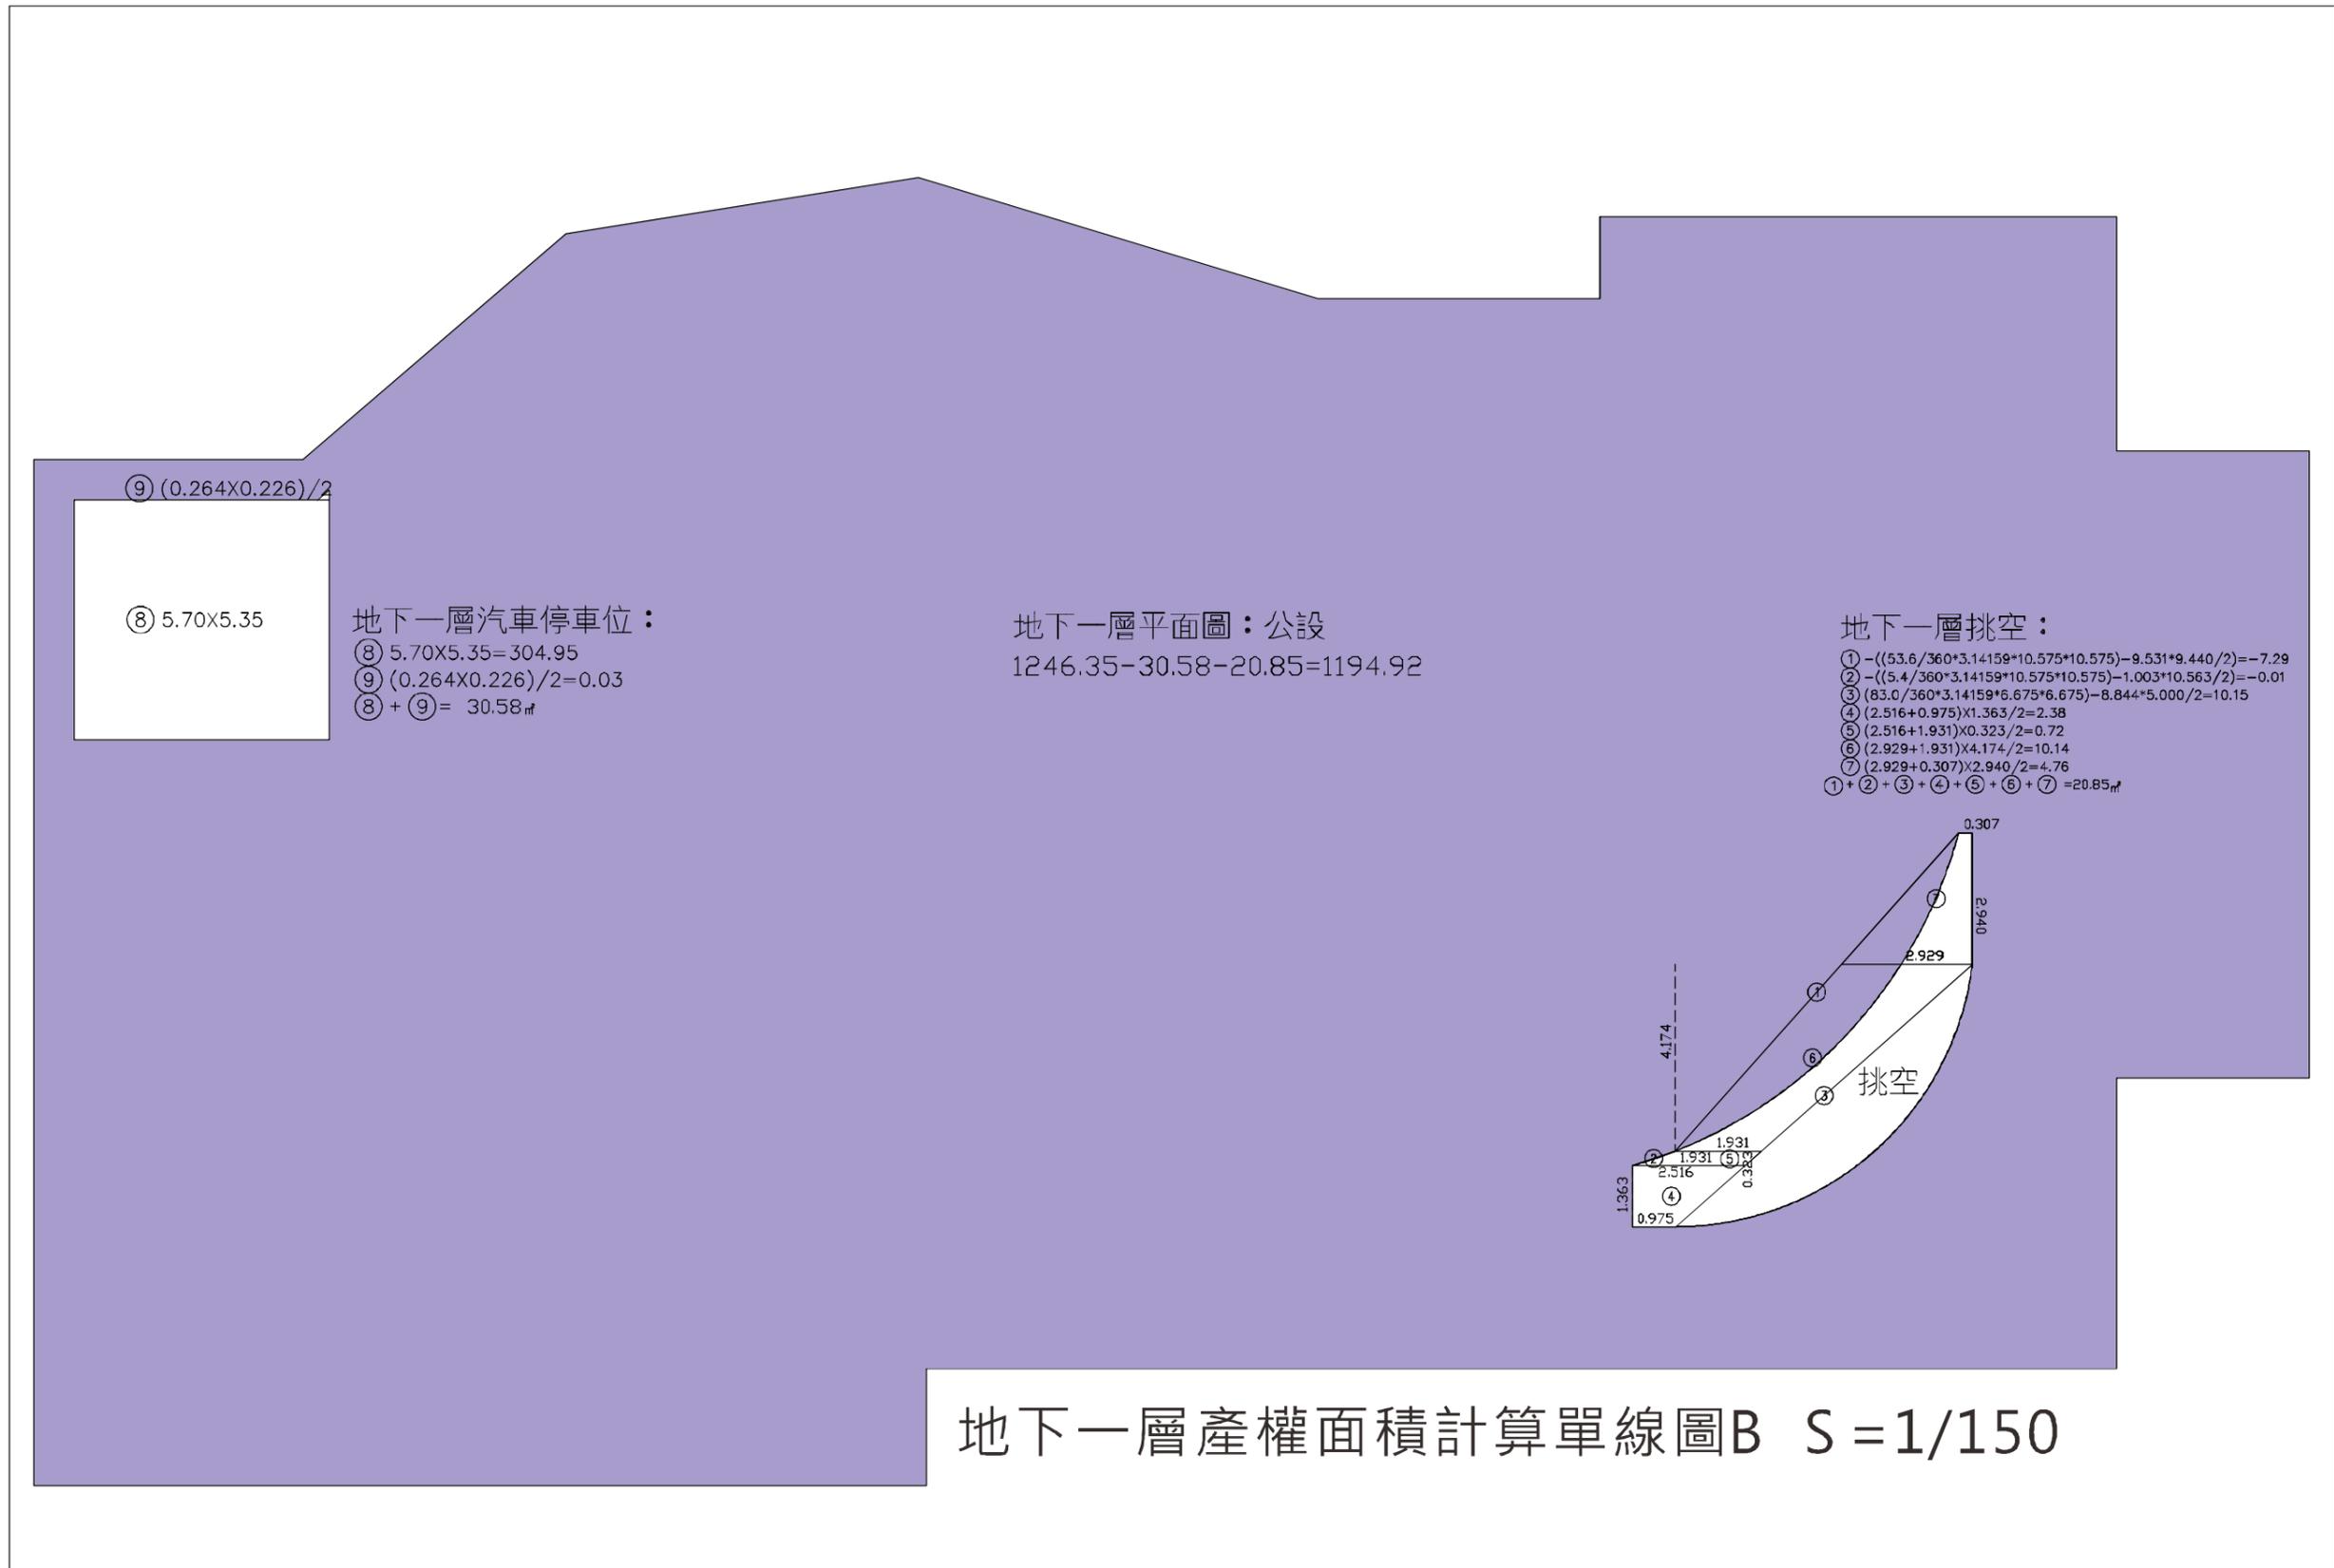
、地下一層產權面積計算單線圖B (S : 1/150)
